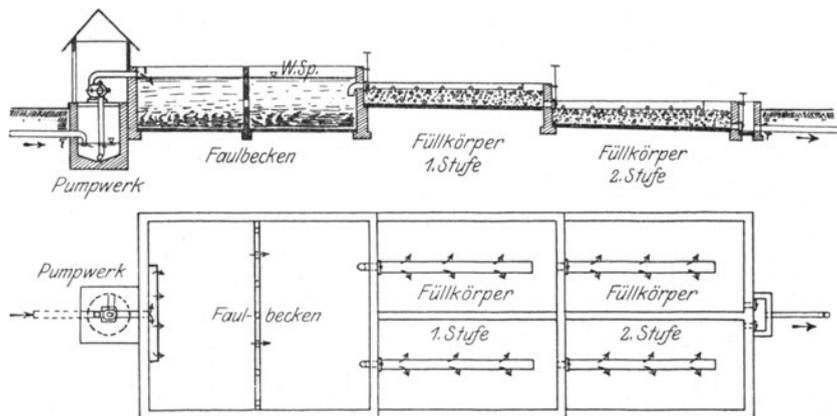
Durchschnitt und Grundriß einer biologischen Füllkörperanlage mit Faulbecken.
